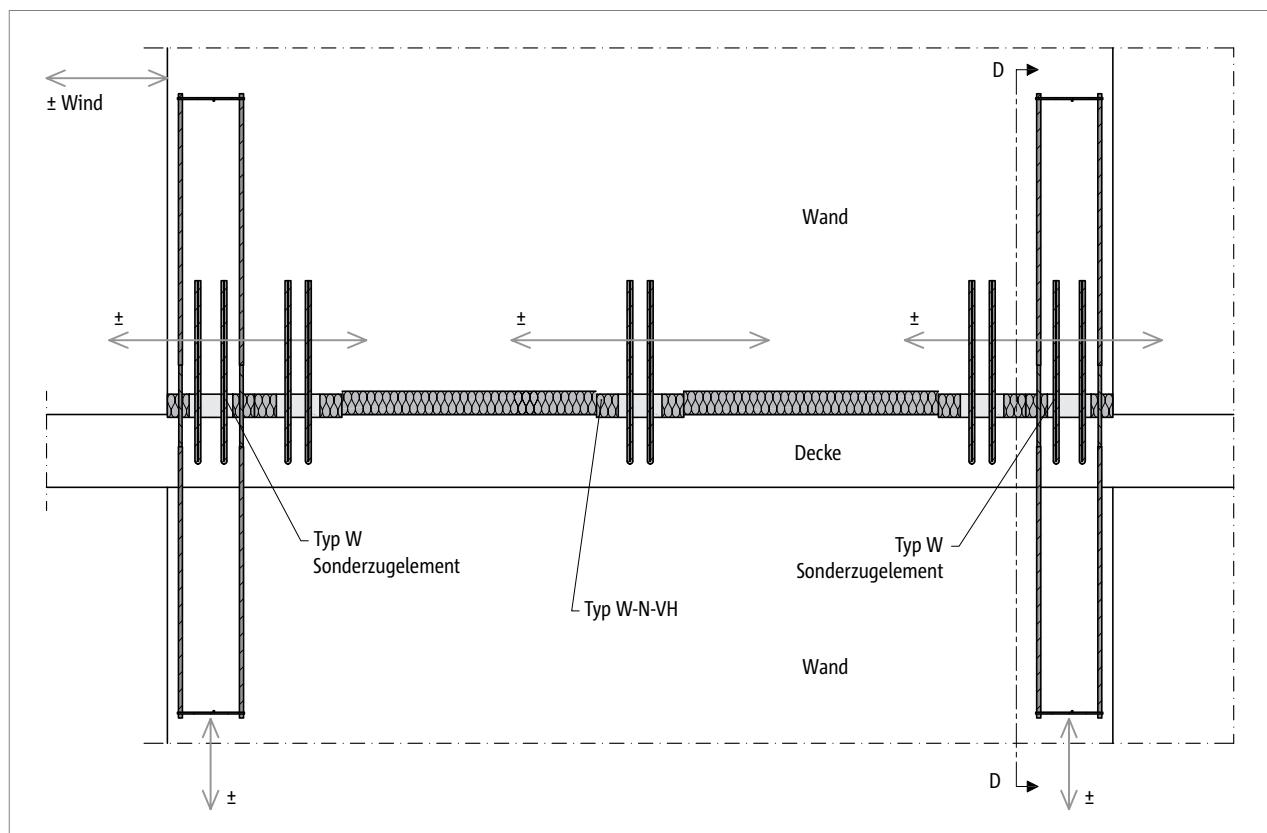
Schöck Sconnex® Typ W: Kombinierte Produktvarianten für den Anschluss einer horizontal belasteten, stabilisierenden Wand
